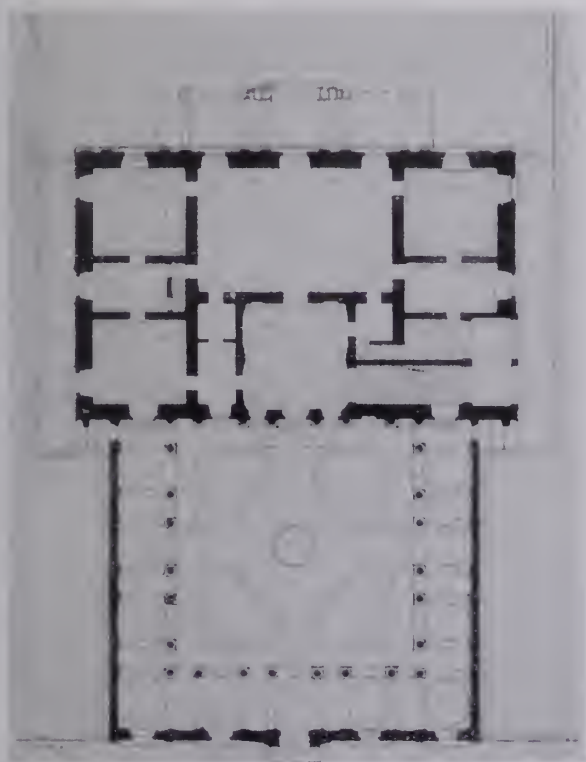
Genova, Palazzo Sauli. Alessi: Pianta del pianterreno.
